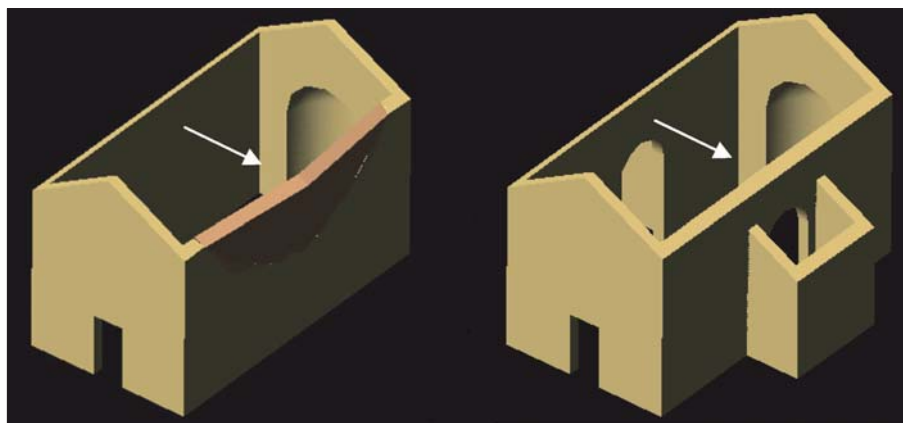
Aggiunta di cappelle laterali nelle chiese a navata unica funzionale alla stabilità delle pareti perimetrali
